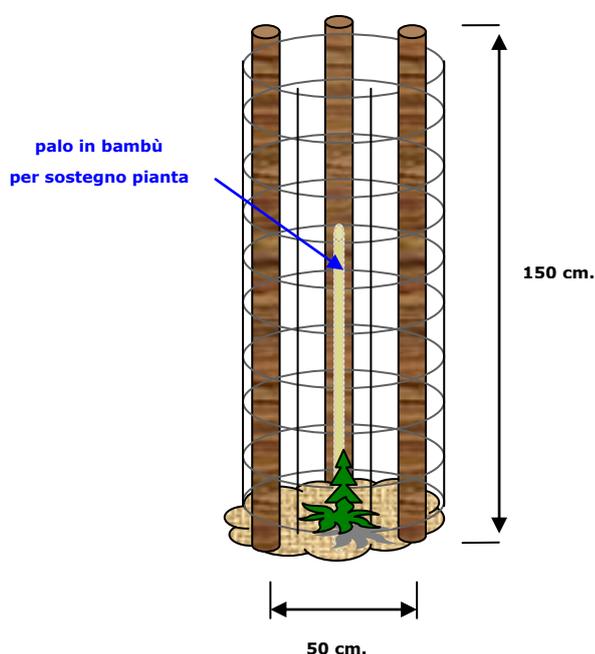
/C - Schema di protezione individuale (la giovane pianta forestale viene legata al palo tutore)
